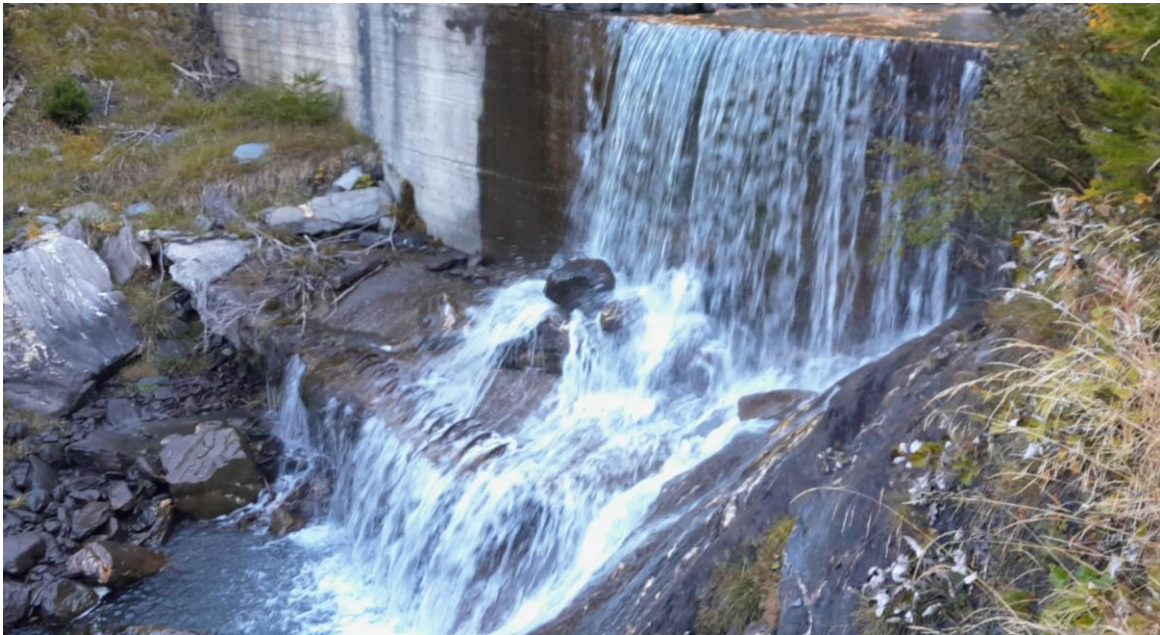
Prise de vue de l'état d'affouillement de la semelle aval du barrage B14.
